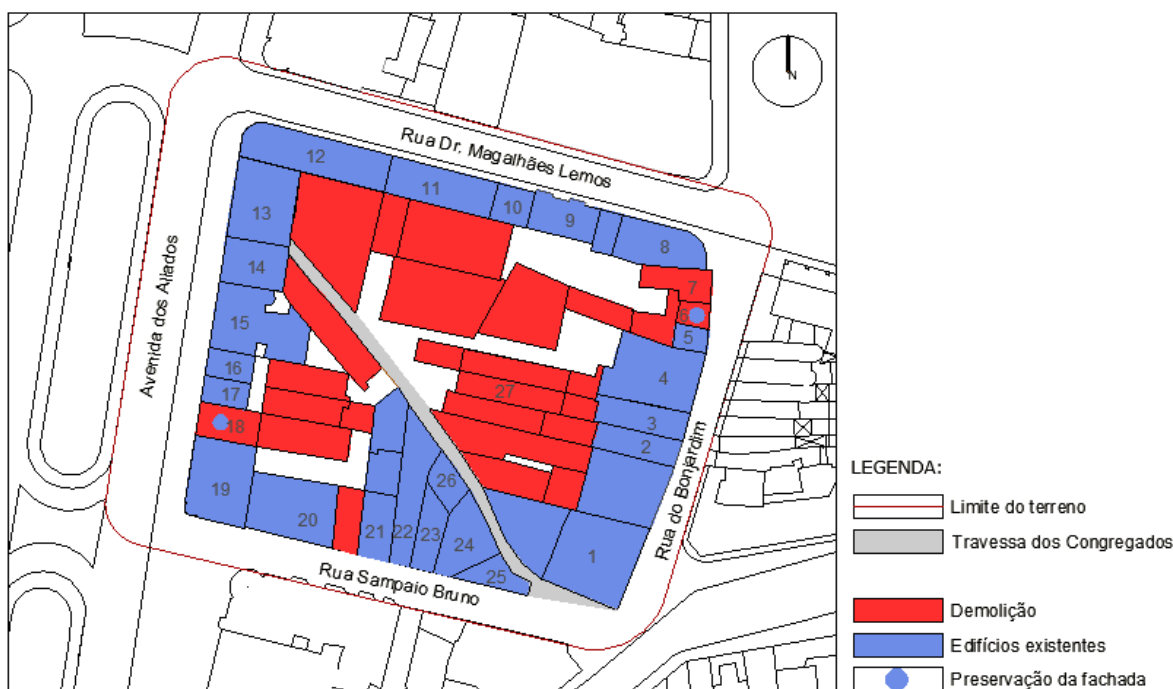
Planta síntese do nível de intervenção no edificado existente.
